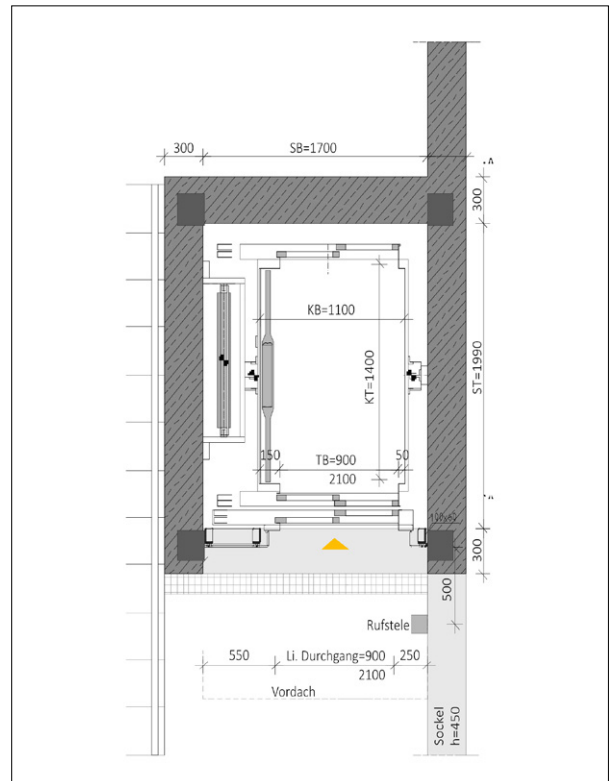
Ausführungsbeispiel eines Außenaufzuges, Grundriss und Pulttafel
